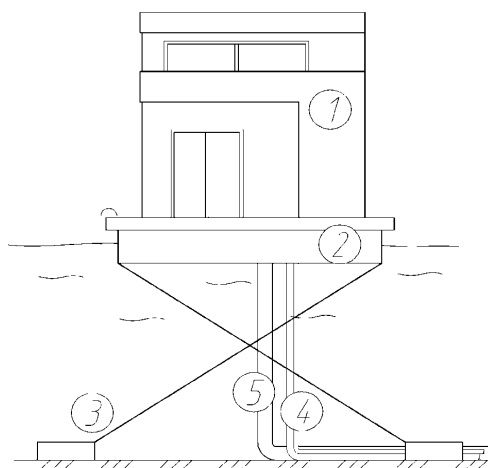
Конструкция плавучего дома на бетонных понтонах:
